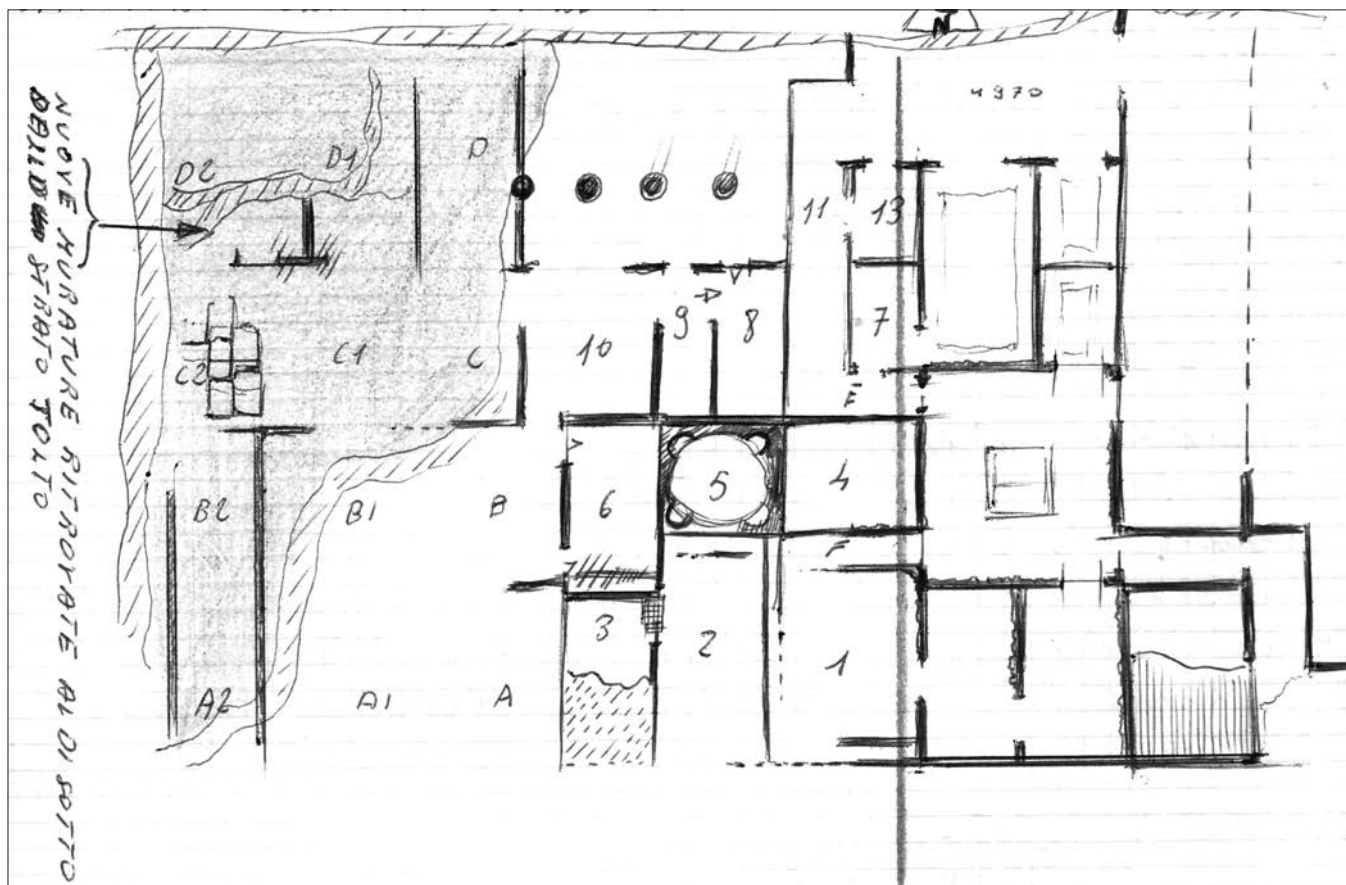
Planimetria dello scavo 1972 - (dal giornale di scavo, Fondo M. Santangelo).
